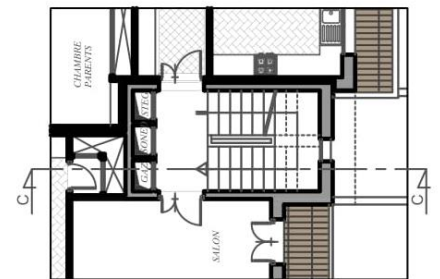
Coffrage des escaliers (ingénieur structure)
